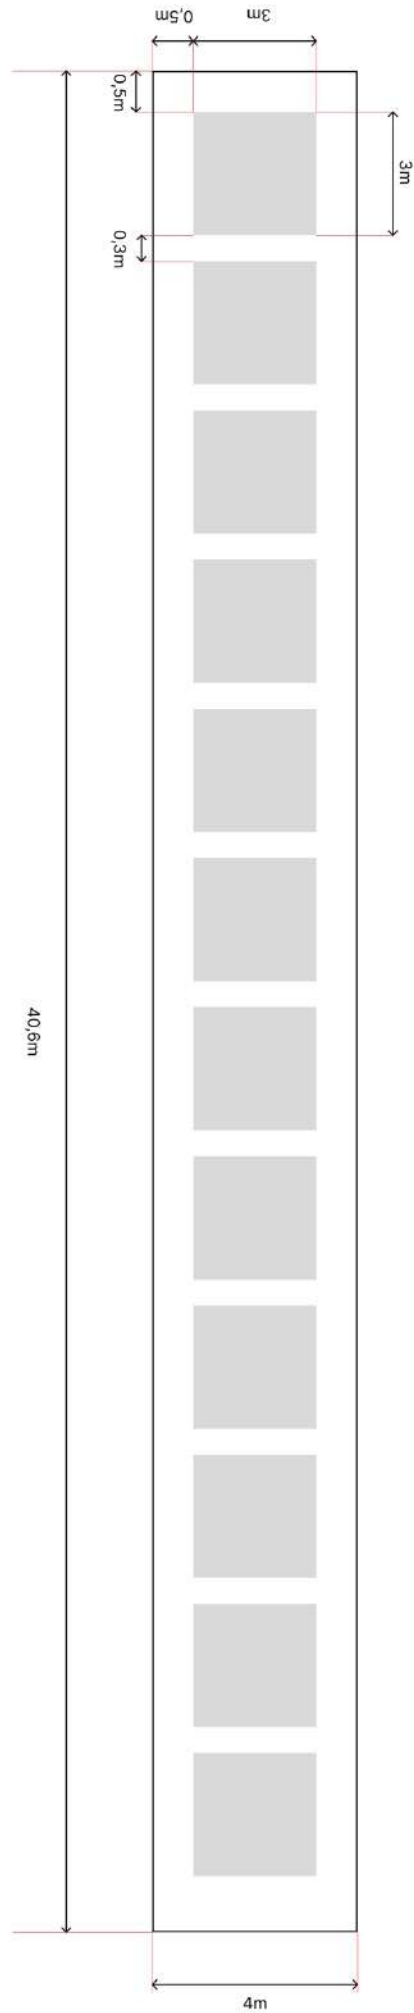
Vista aérea piletón Fuente: elaboración del autor
